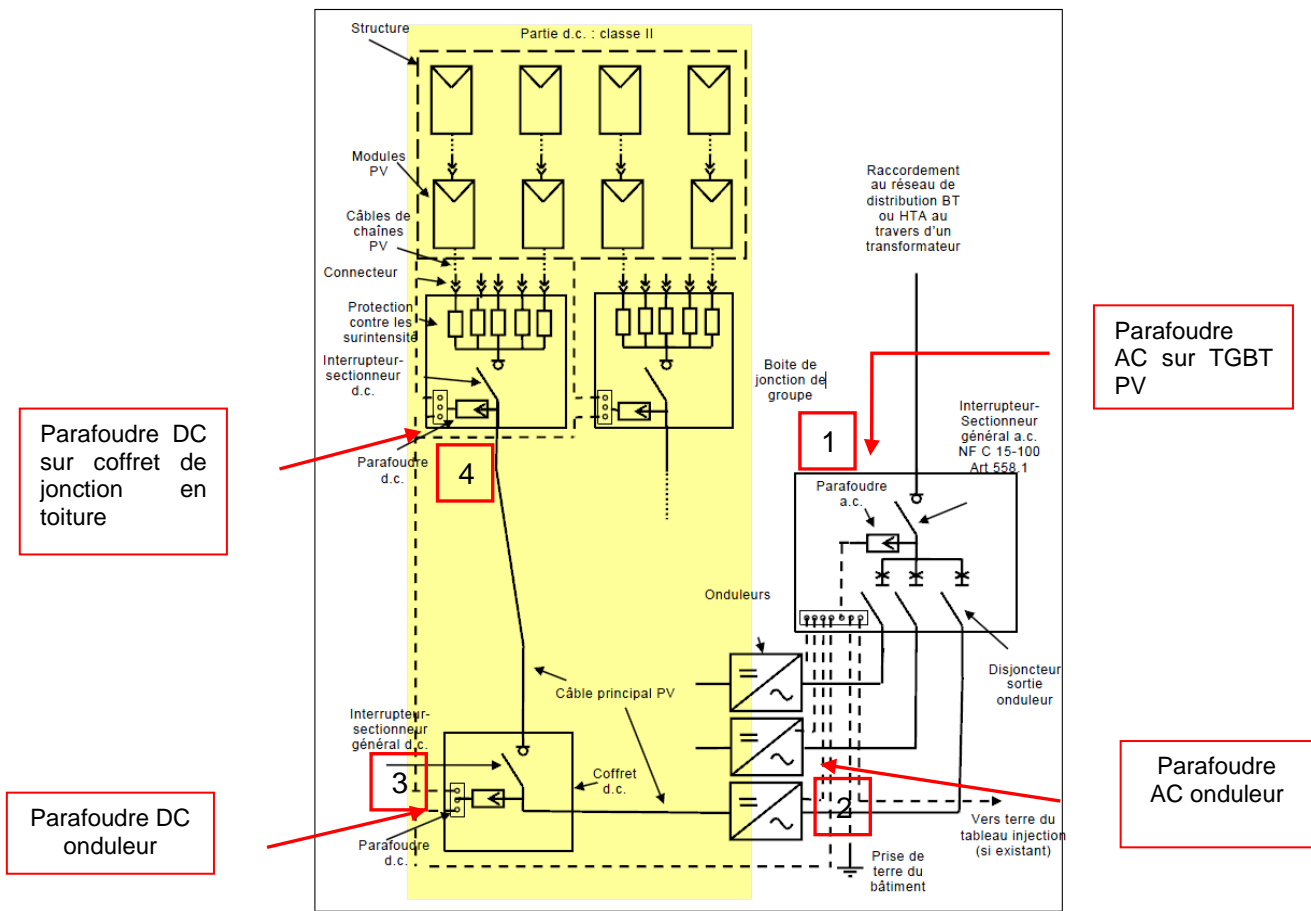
Implantation des parafoudres sur l'installation PV. (UTE 15-712)
